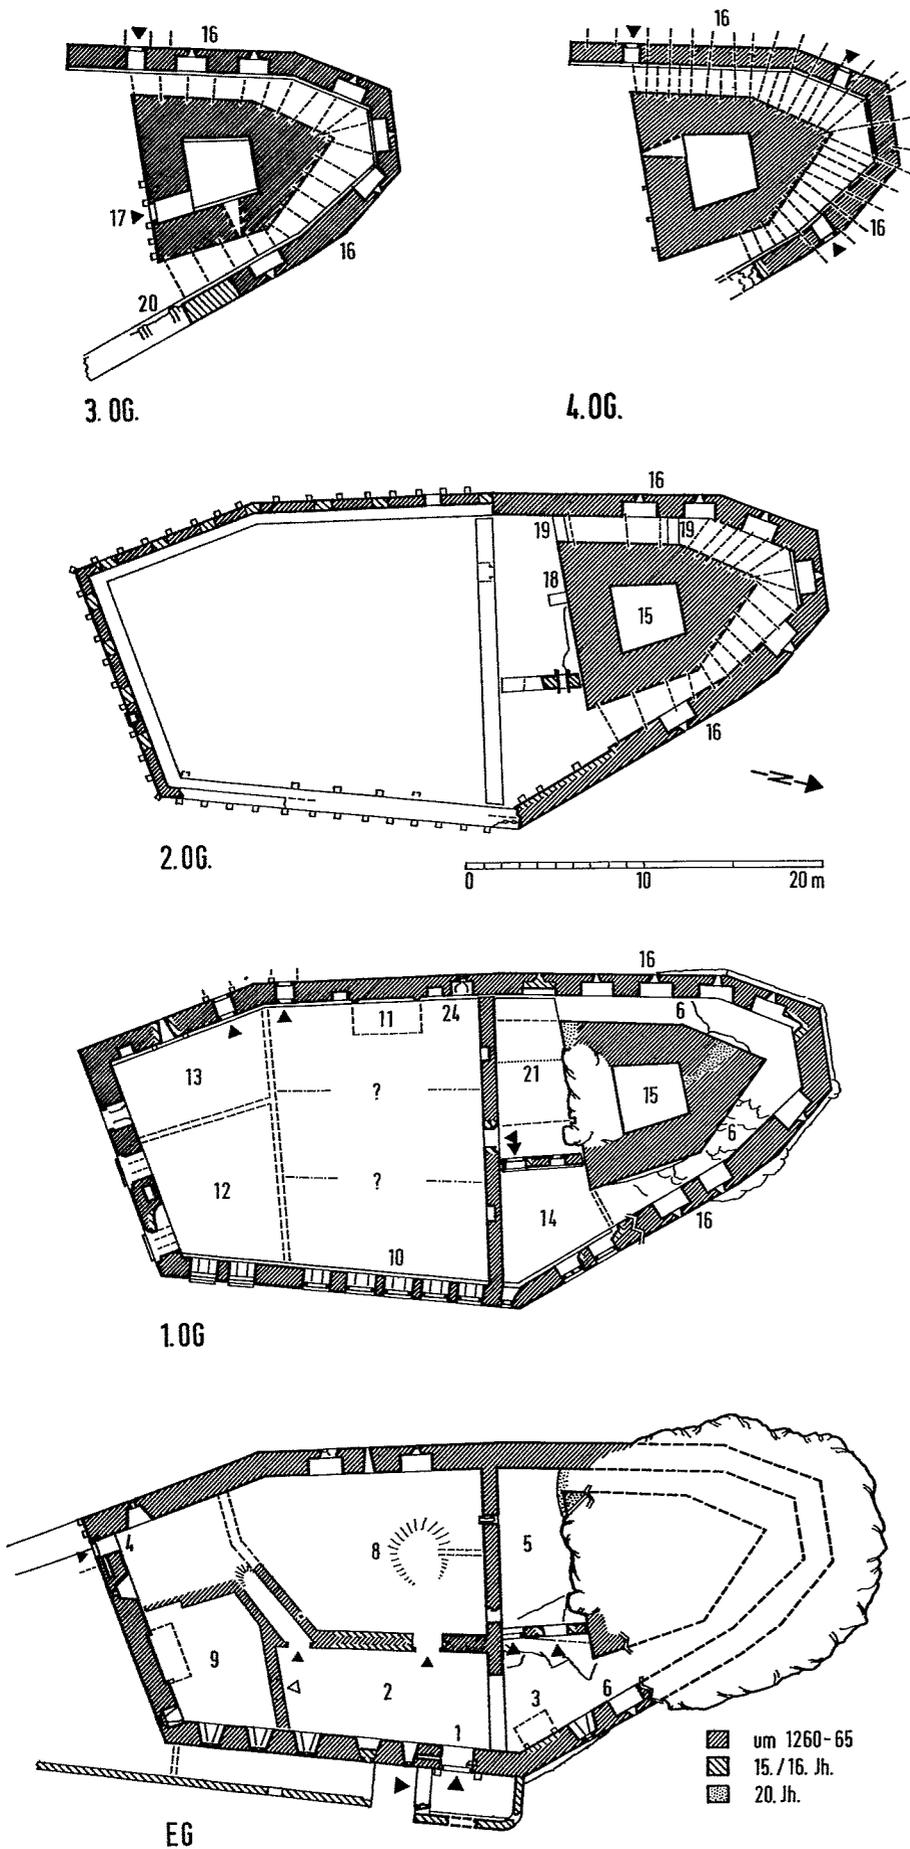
Ortenberg, Grundrisse mit Baualterangaben (Th. Biller unter Verwendung des Grundrisses von B. Ebbardt).
